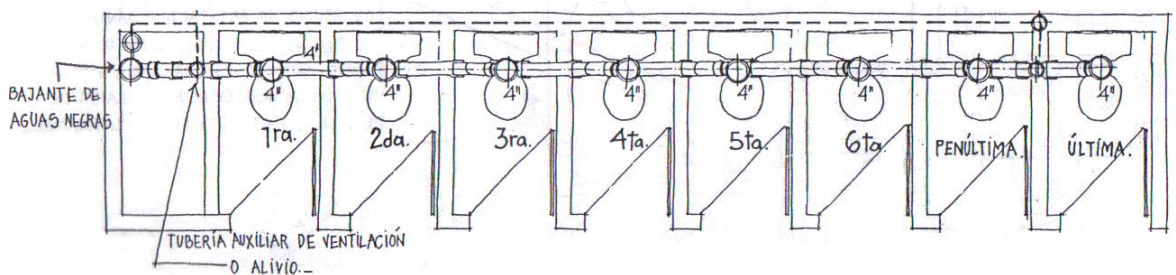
Ventilación en Conjunto para aparatos alineados - Planta
